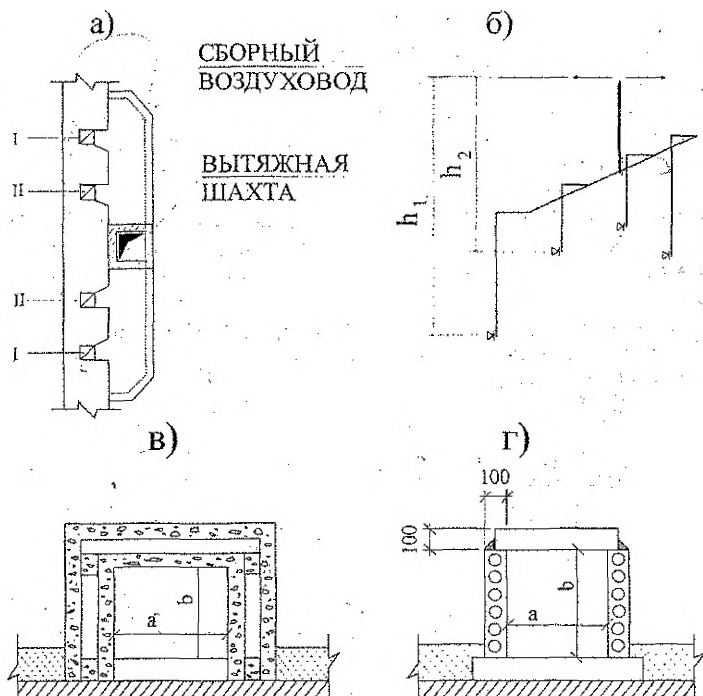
Вентшахта с объединенными вентканалами: а) схема объединения вертикальных каналов на чердаке; б) аксонометрическая схема каналов вентсистемы; в) сборный воздуховод из двойных гипсошлаковых плит; г) сборный воздуховод из шлакобетонных плит
